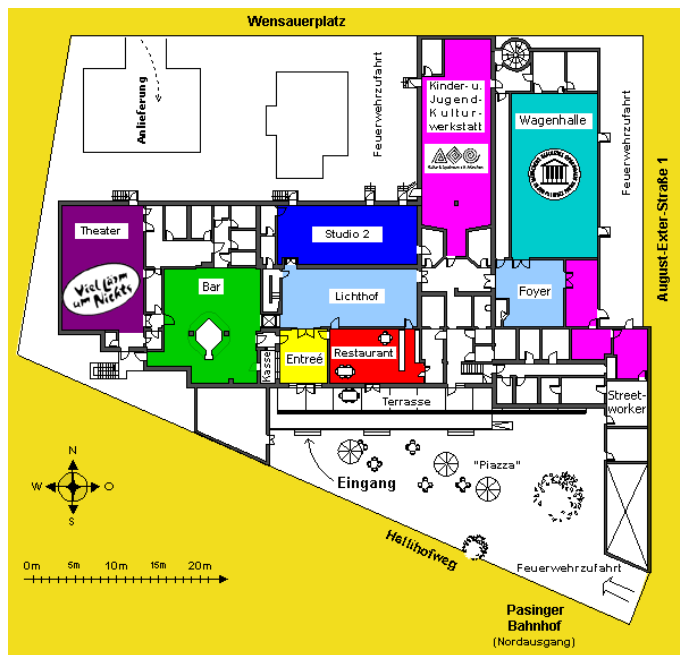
Grundrißschema *Pasinger Fabrik*, München
